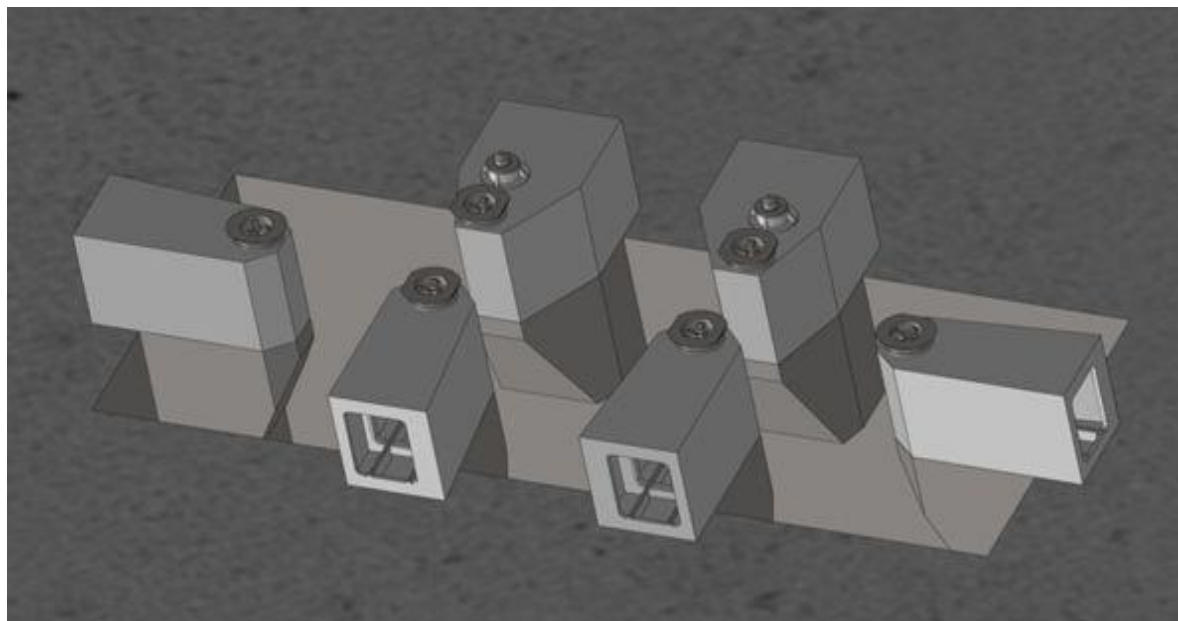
Общий вид ПУ для РКН с двумя боковыми блоками
